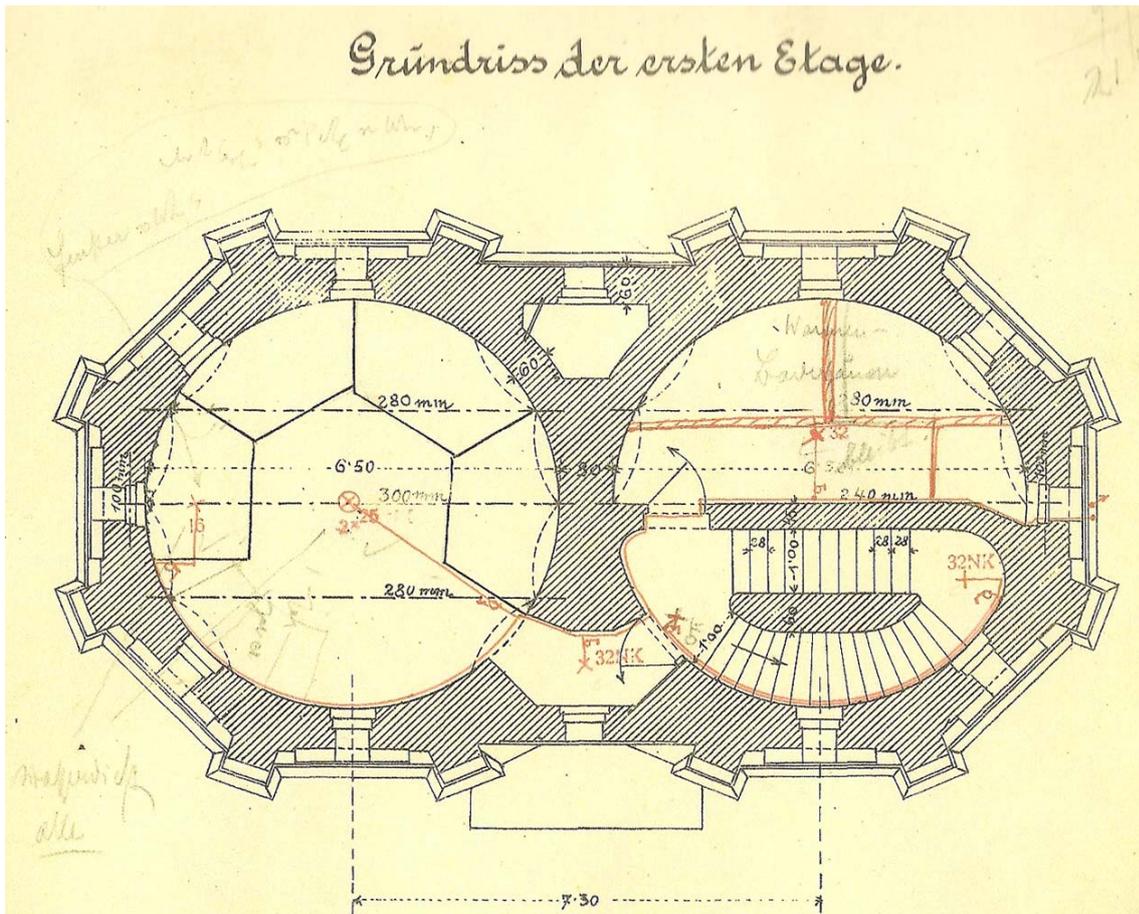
Grundriss der ersten Etage, Ausführungsplan der k. k. Staatsbahnen, 1904
